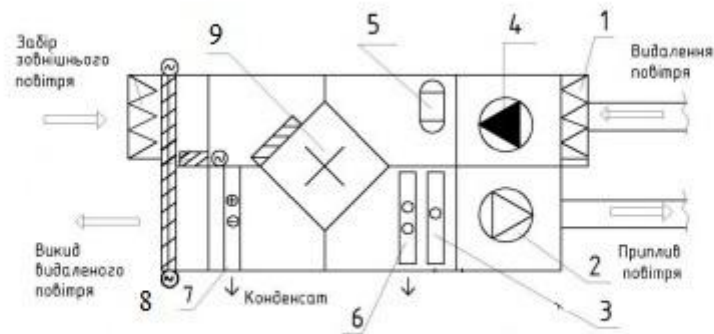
Схема вентиляційного обладнання для вентиляції та кондиціювання навчального закладу: 1 – повітряний фільтр, 2 – припливний вентилятор, 3 – зимовий догрів, 4 – витяжний вентилятор, 5 – тепловий насос, 6 – теплообмінник теплового насоса 1, 7 – теплообмінник теплового насоса 2, 8 – фільтр зовнішнього повітря, 9 – пластинчастий рекуператор
